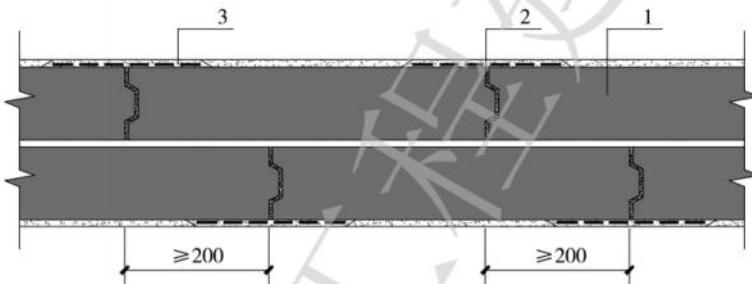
双层条板隔墙竖向拼缝示意图(单位:mm)
